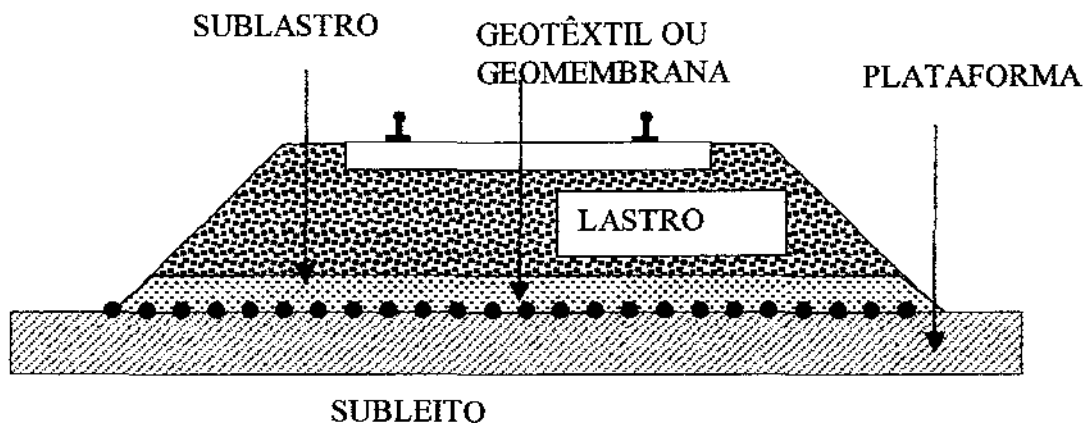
Secção transversal de via férrea tendo o geotêxtil ou geomembrana como elemento de proteção filtrante do lastro ou do sublastro.
